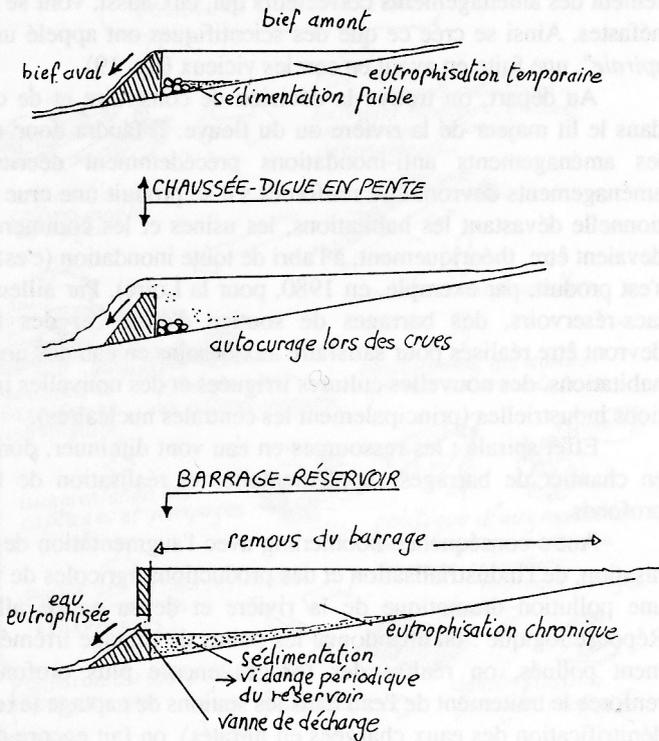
Les deux techniques de retenues sur rivière . la chaussée-digue en pente et le barrage-mur.
